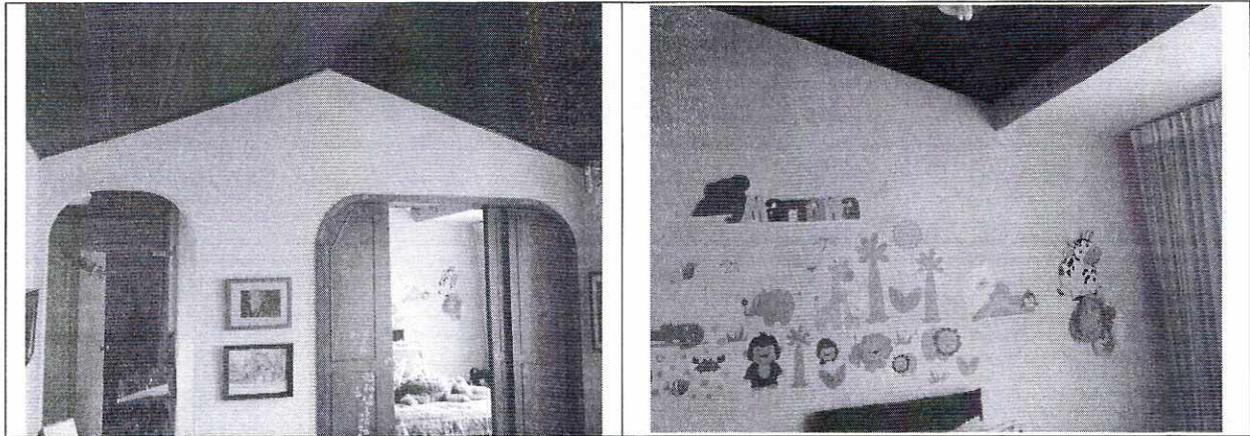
Vista interior apartamento 302. Agrietamiento muro
